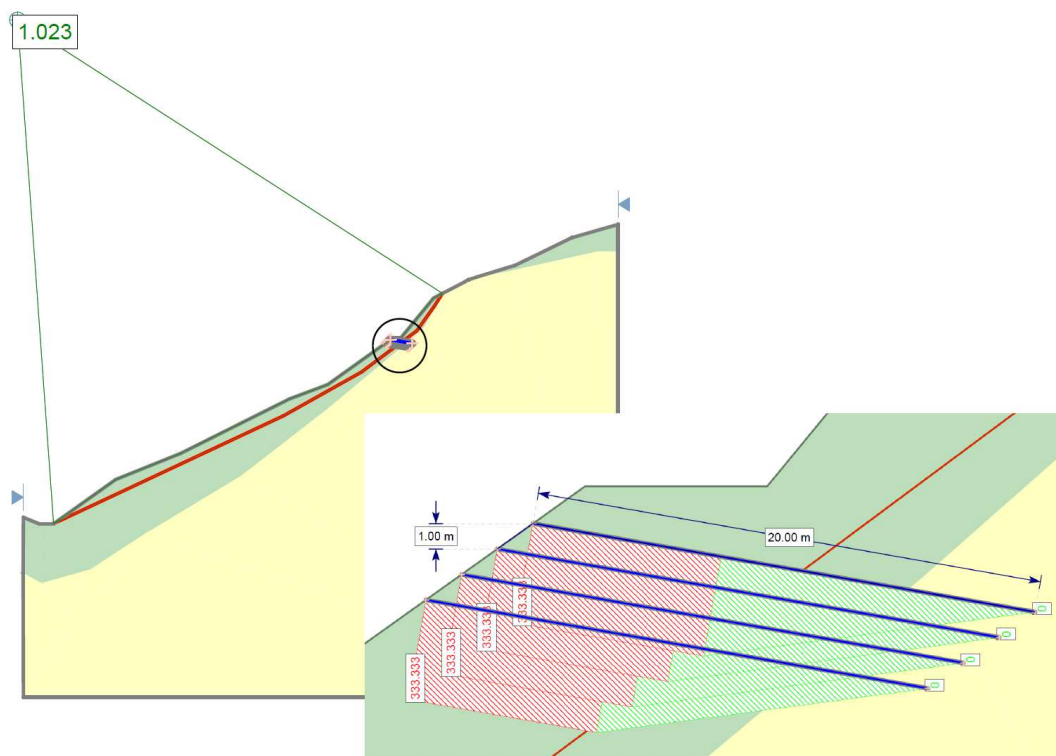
Verifica di stabilità sulla sezione 2 con l'introduzione del soil nailing
